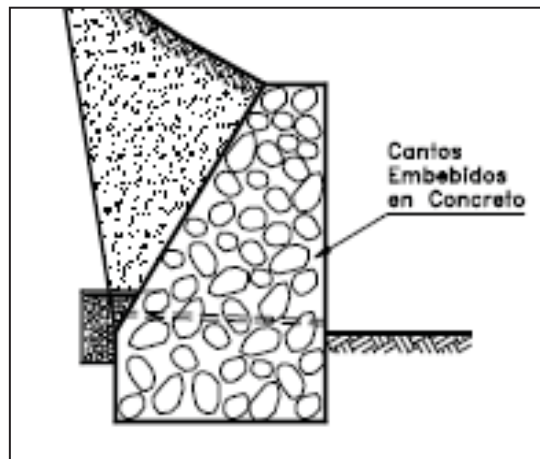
Muros de concreto ciclópeo. (Fuente:
